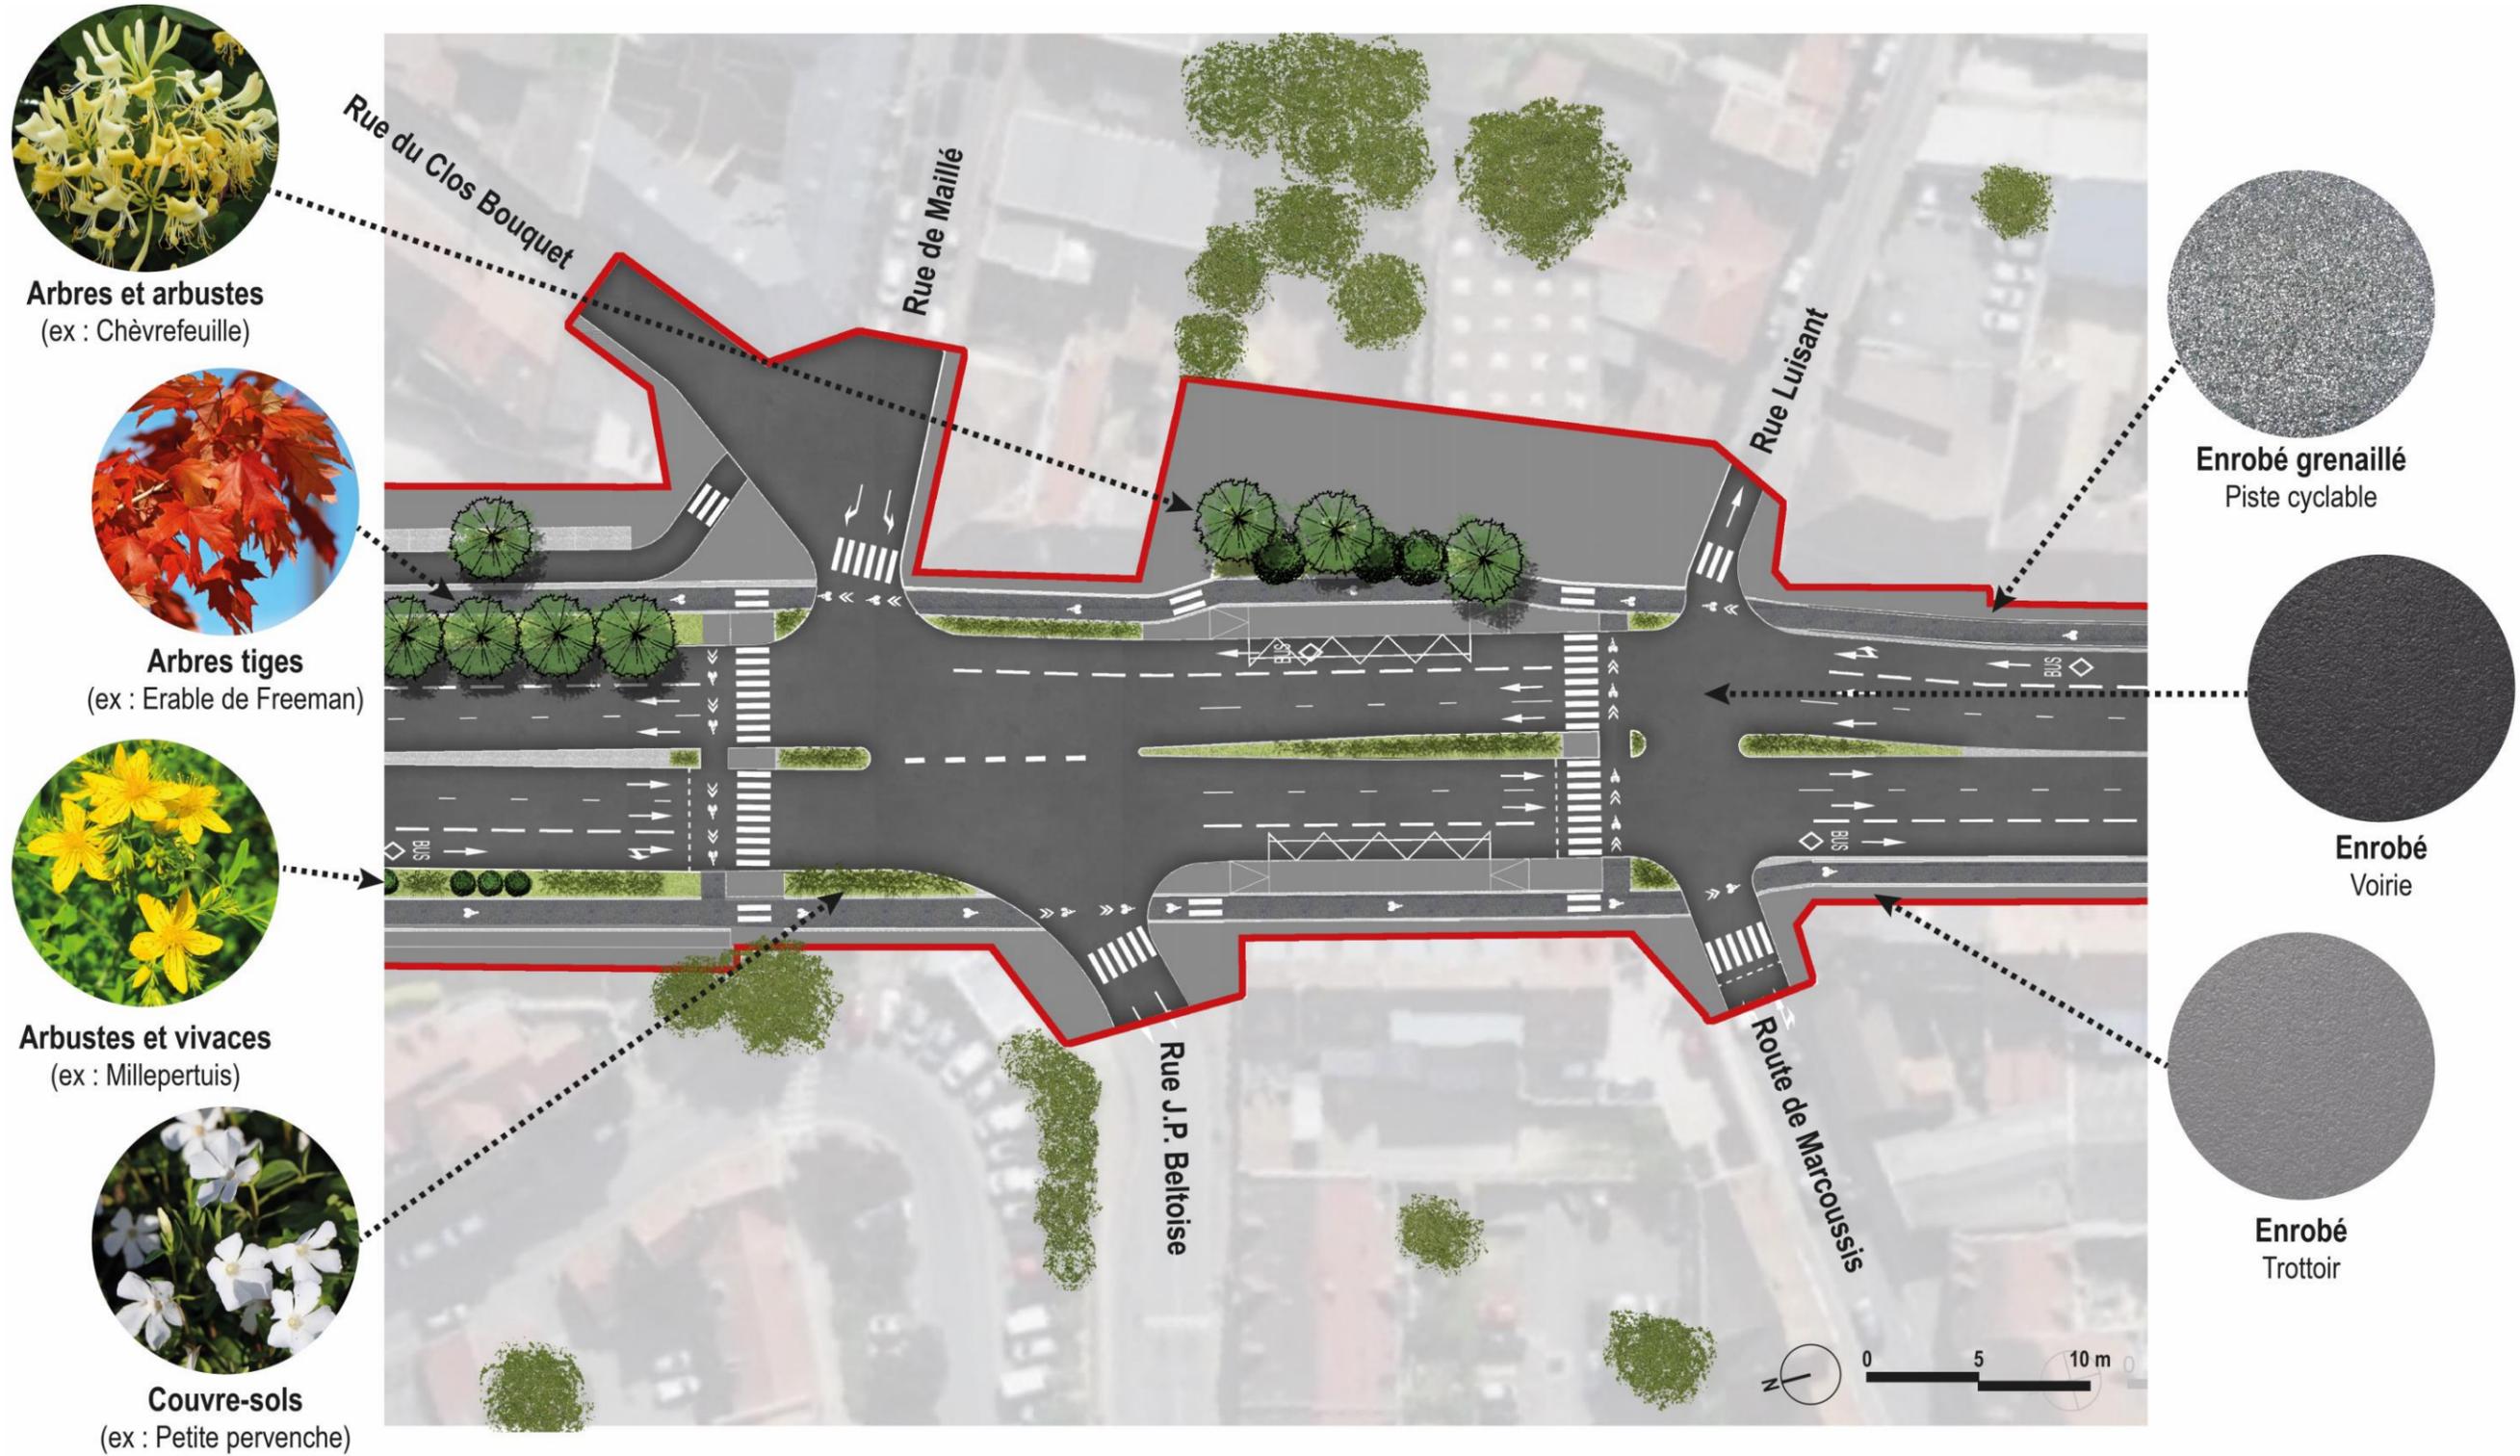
Planche d'aménagement de la place de l'Europe, Source : Ingérop
